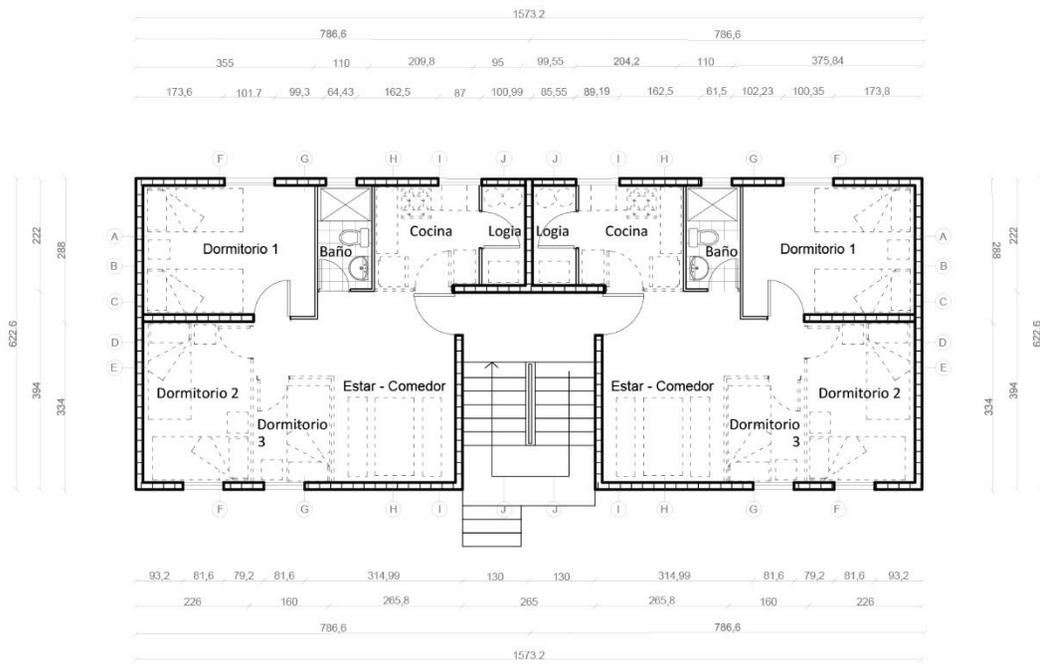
Plano tipología n°2 Marta Brunet, escala 1:150. Fuente: Elaboración propia.
